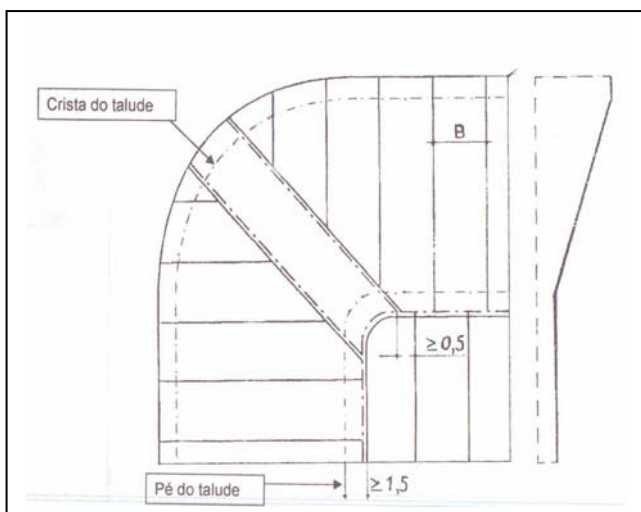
Disposição dos Faixas de Geomembrana nas Células
